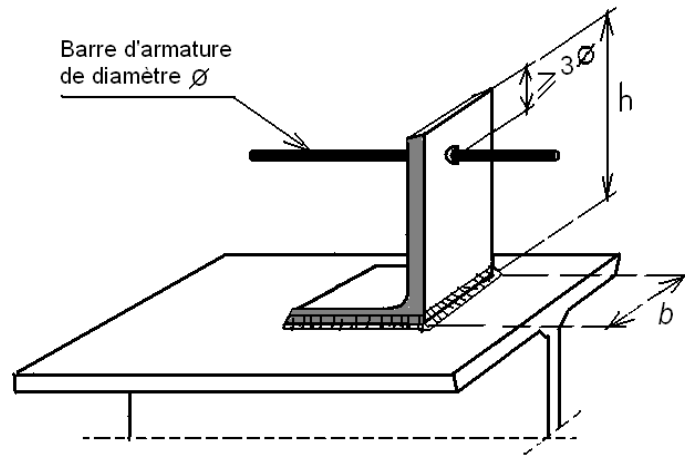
Dimensions d'une cornière soudée avec filant
